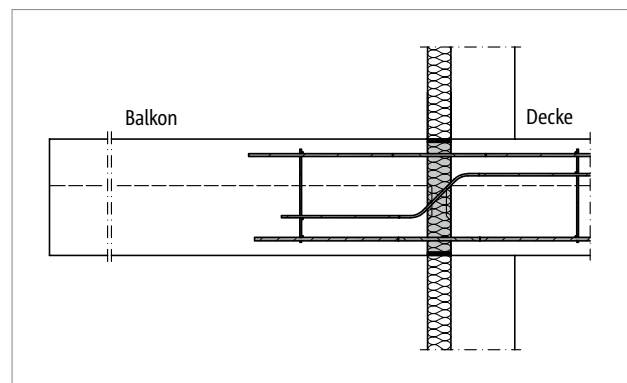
Schöck Isokorb® T Typ BP: Balkonkonstruktion mit frei auskragenden Unterzügen
